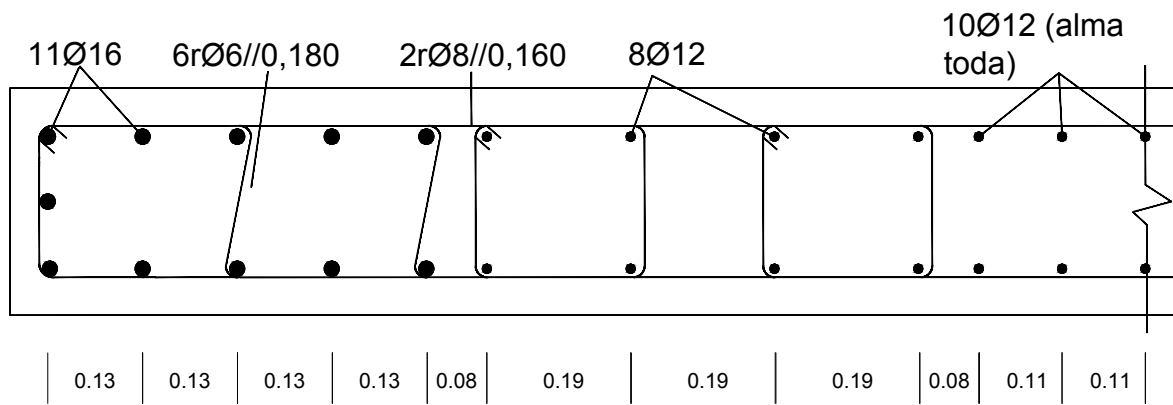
Armadura final da parede 1 do piso 5 ao 9.
